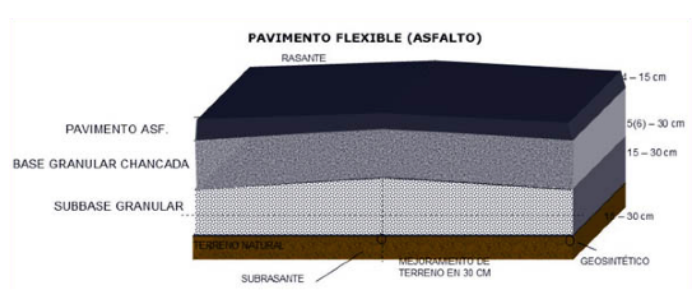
Estructura interna de un pavimento flexible o de asfalto.
